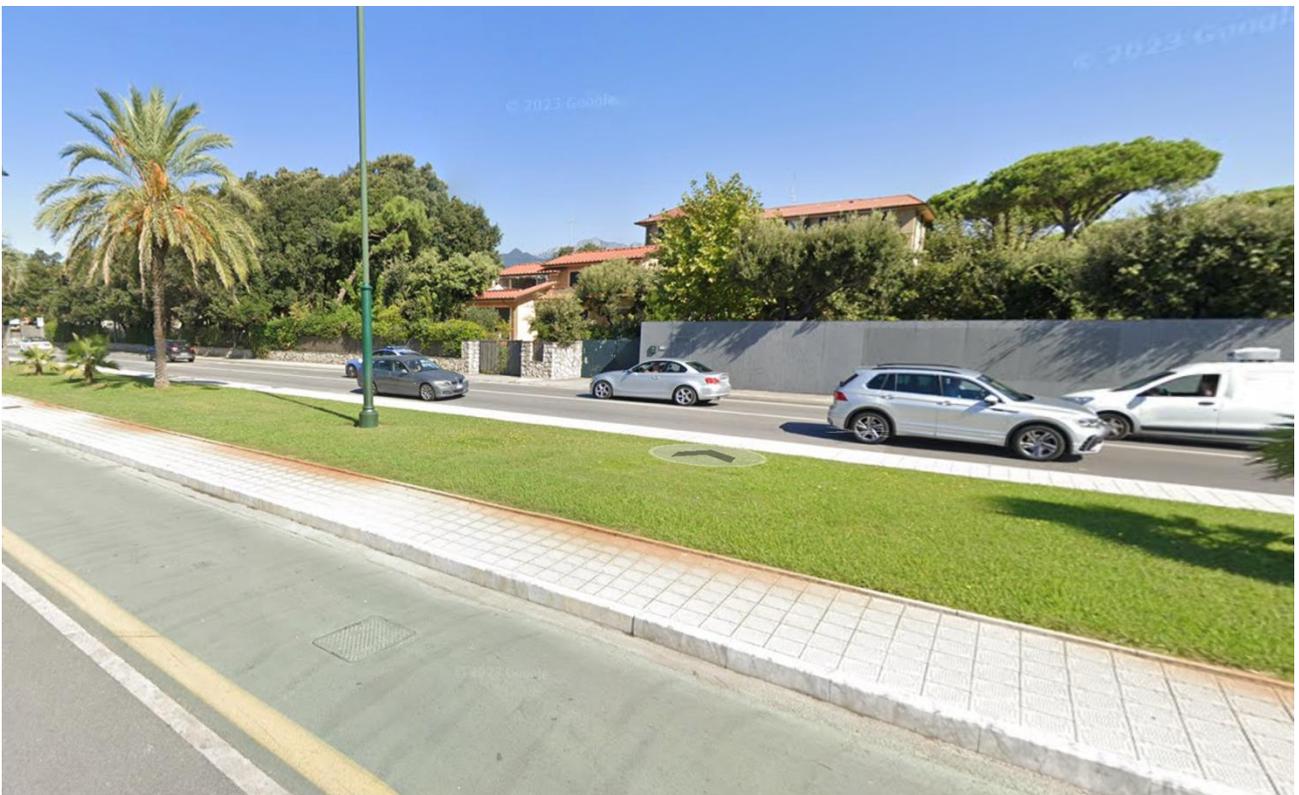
Immagine tratta da Google Earth- Street view sul Viale della Repubblica
